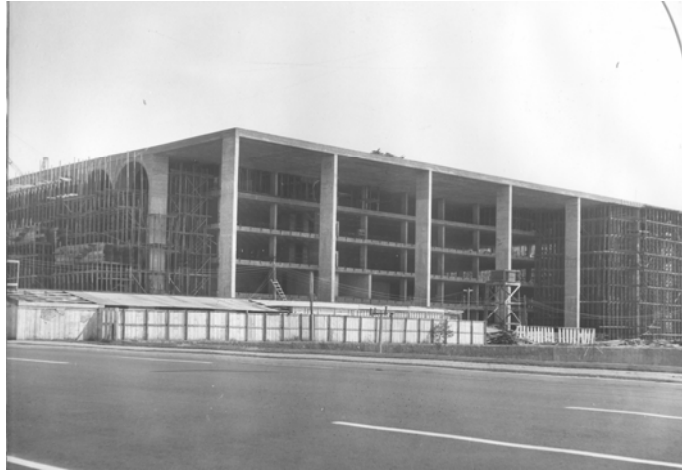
Desforma da fachada leste (Divisão de Obras – MJ)
